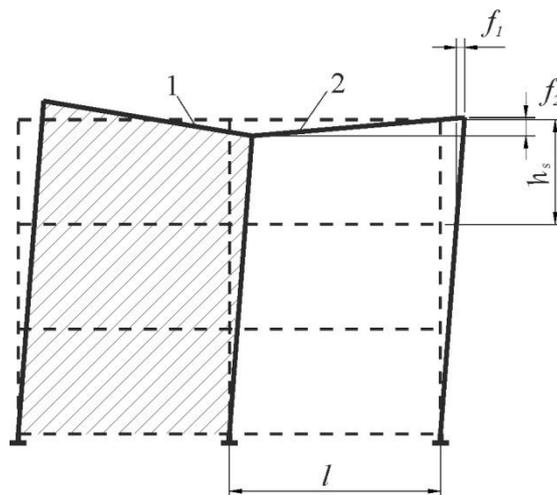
Схема перекоса этажных ячеек 2, примыкающих к диафрагмам жесткости 1 в зданиях со связевым каркасом (пунктиром показана исходная схема каркаса до приложения нагрузки)
